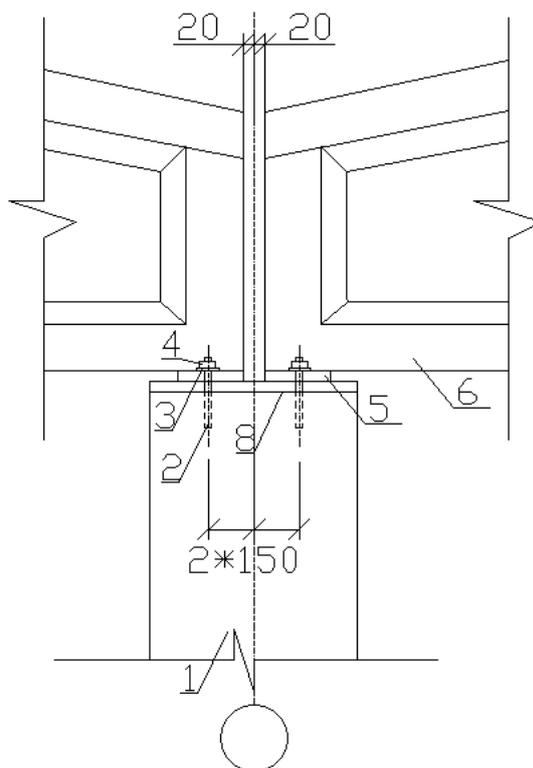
Конструкция соединения ригеля с колонной на анкерных болтах и монтажной сварке вид сбоку: 1-ось ряда, 2-анкеры, 3-шайба, 4-гайка, 5-стальная пластинка  $t=12\text{мм}$ , 6-ригель, 7- колонна, 8- торцевая стальная плита.
